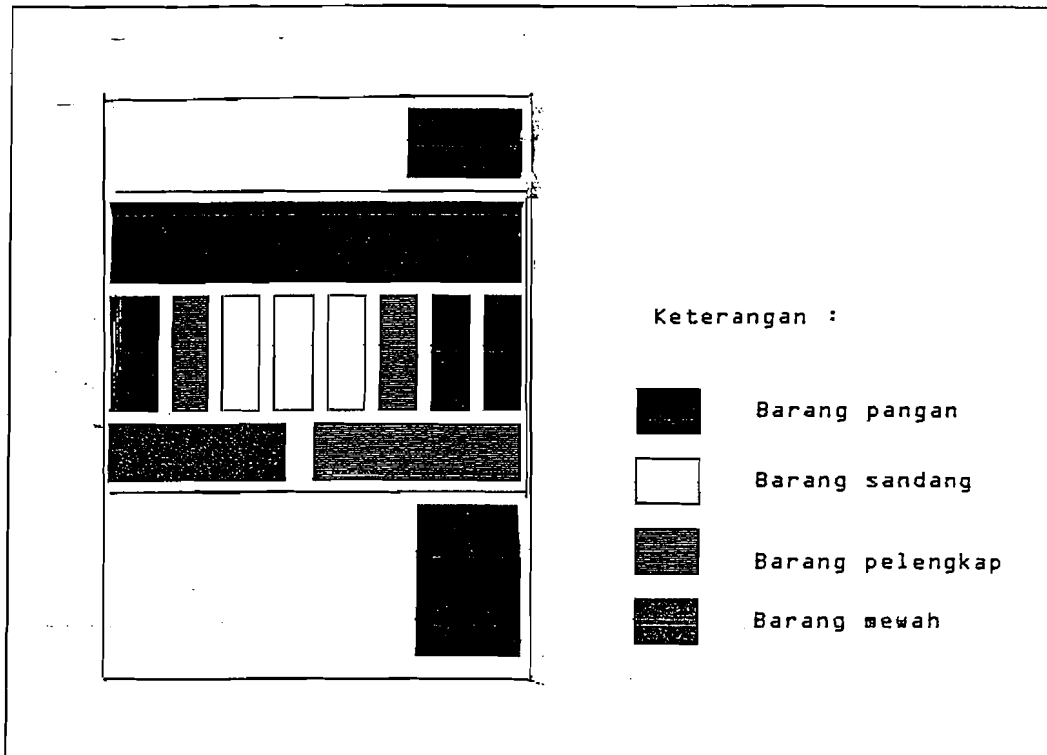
Ploting Barang Dagangan Berdsasarkan Jenis Barang
